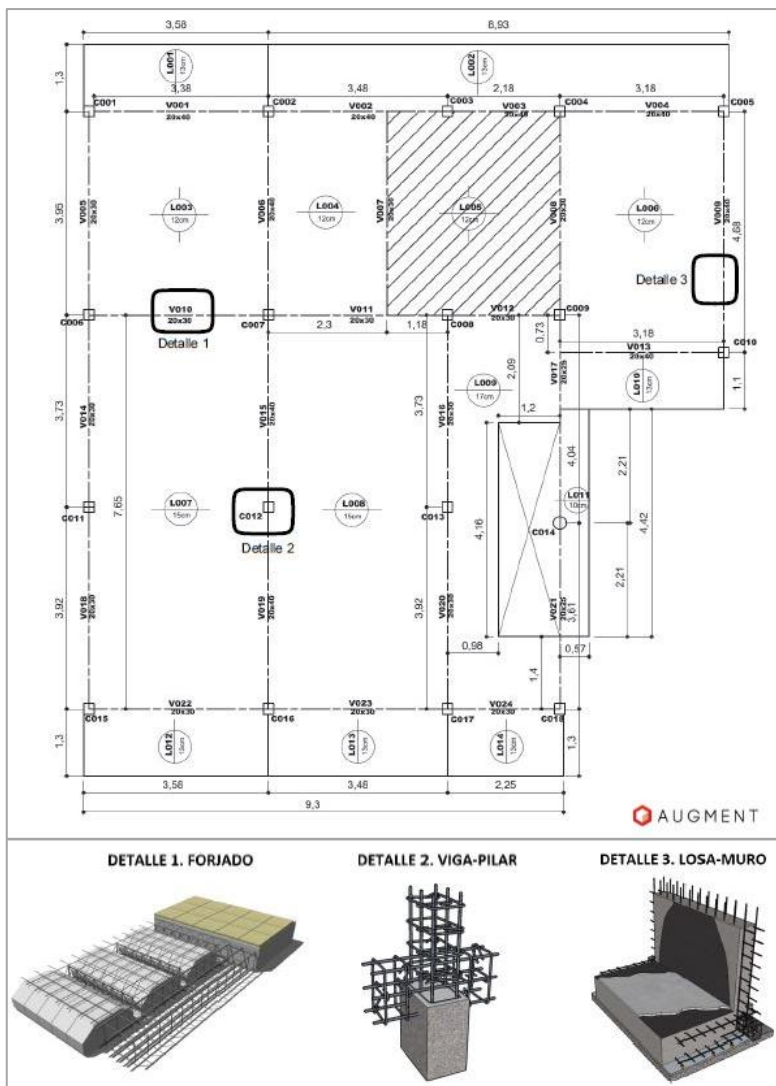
Plano con marcadores de detalles constructivos en RA.
